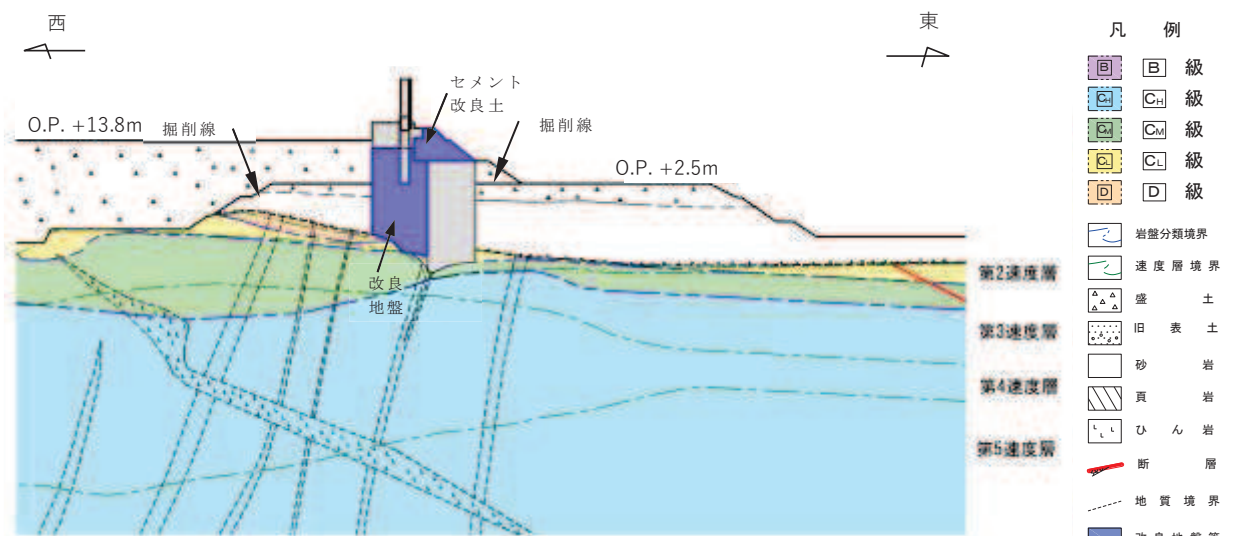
取水口の地質断面図 (㉕-㉕断面)
